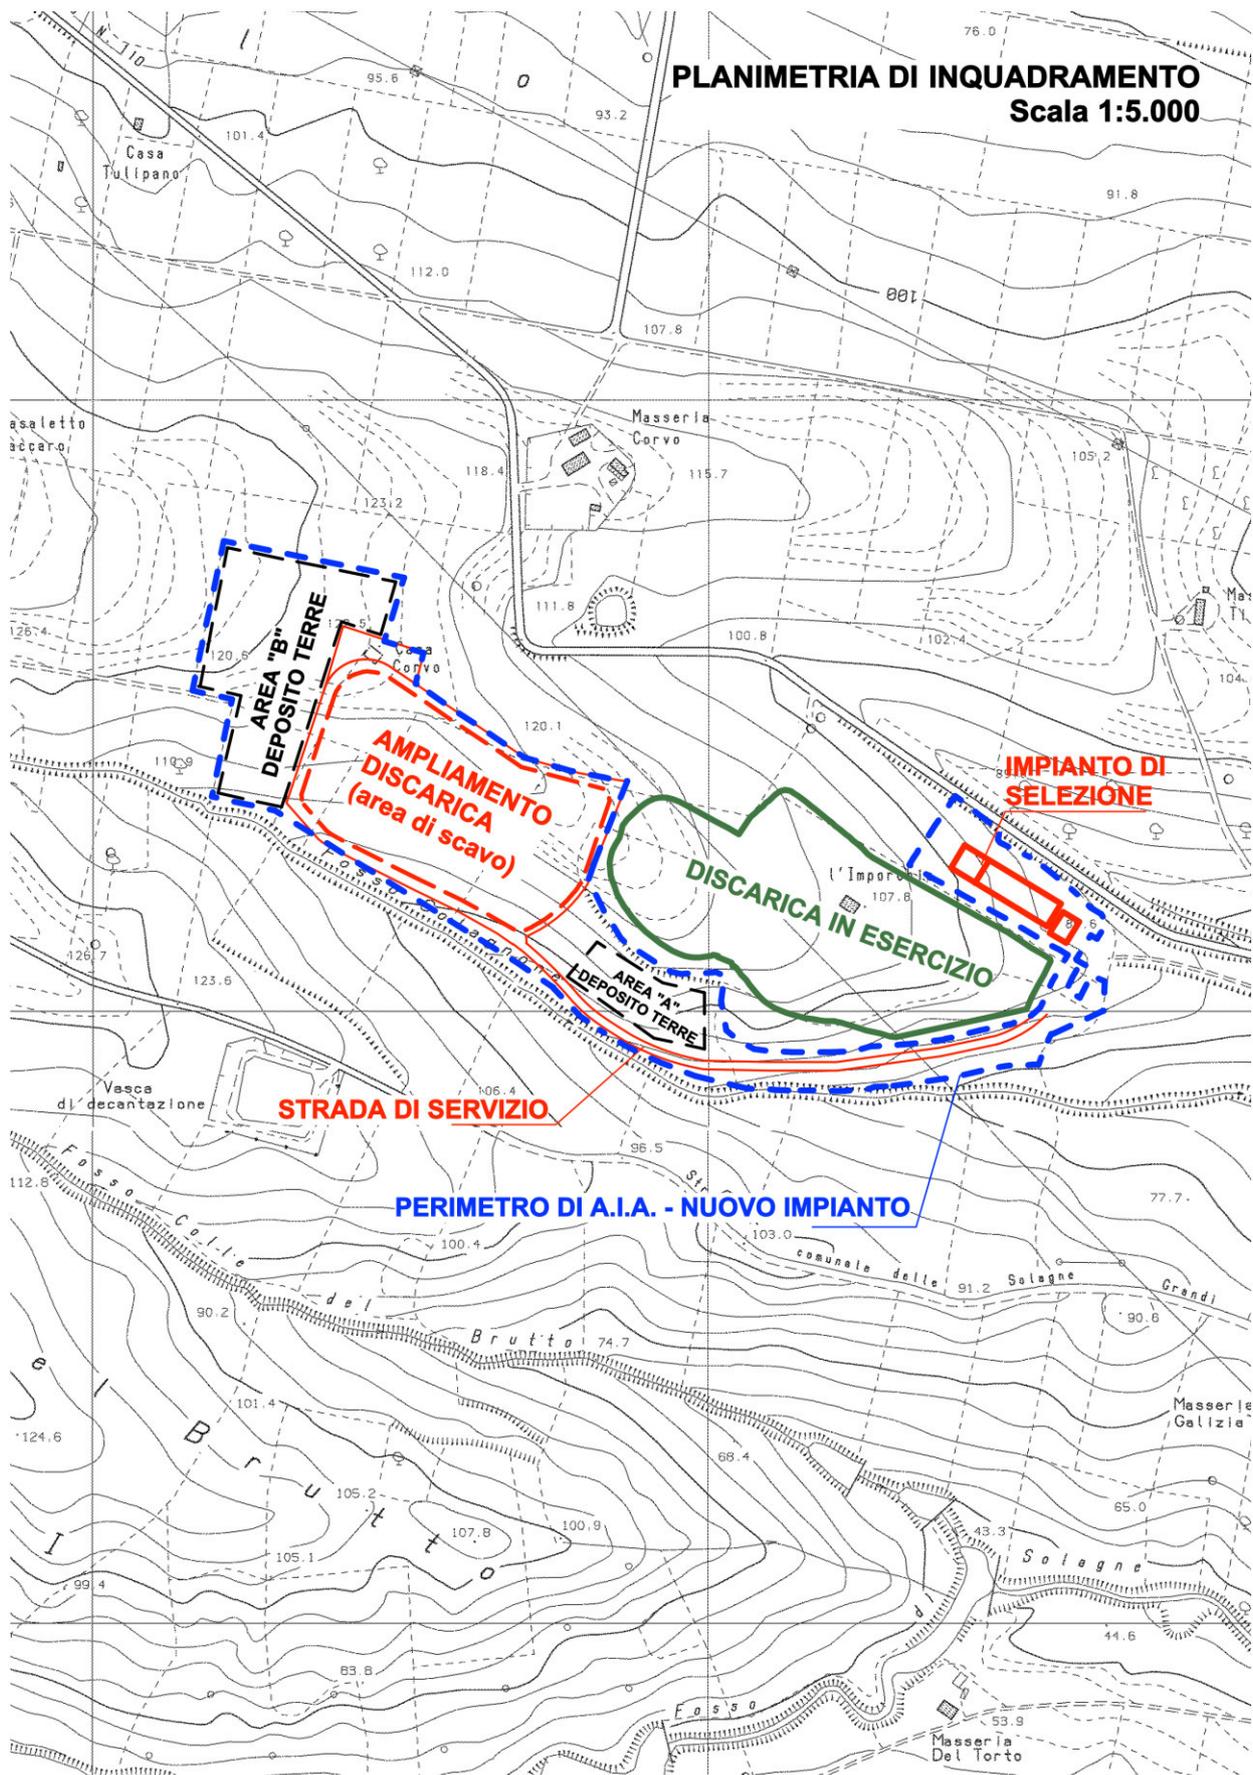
planimetria generale di intervento: assetto “post operam”
